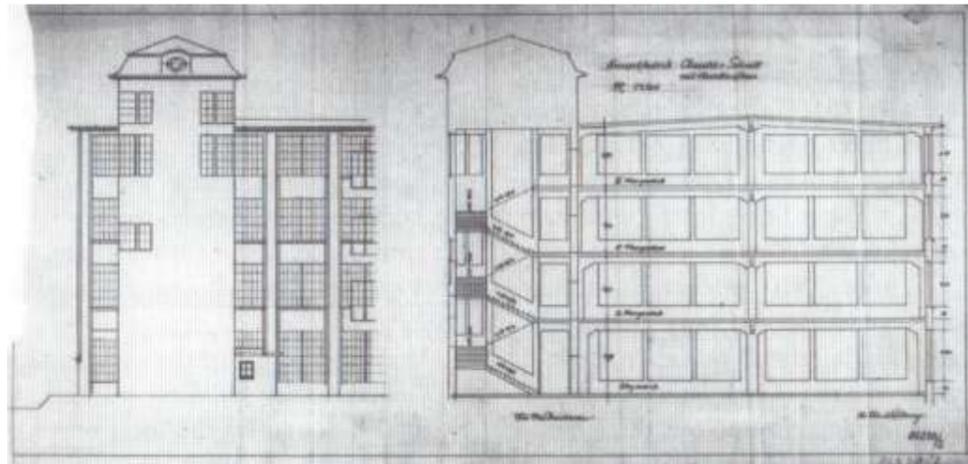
Umbau 1942 Aufriss und Grundriss
